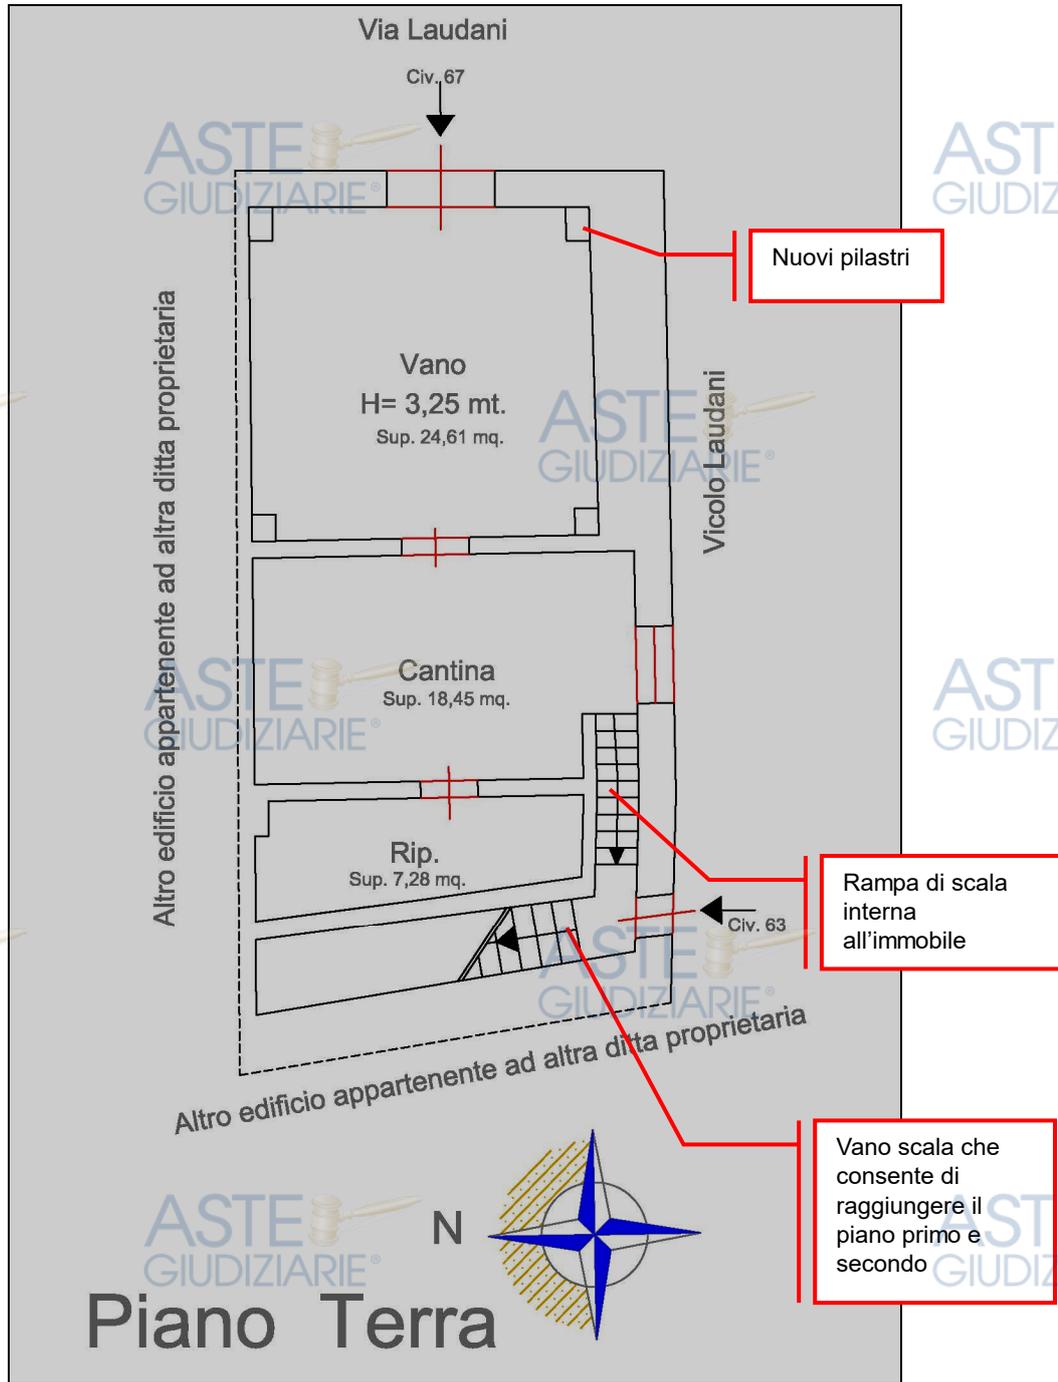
Visualizzazione della planimetria dell'immobile a piano terra
